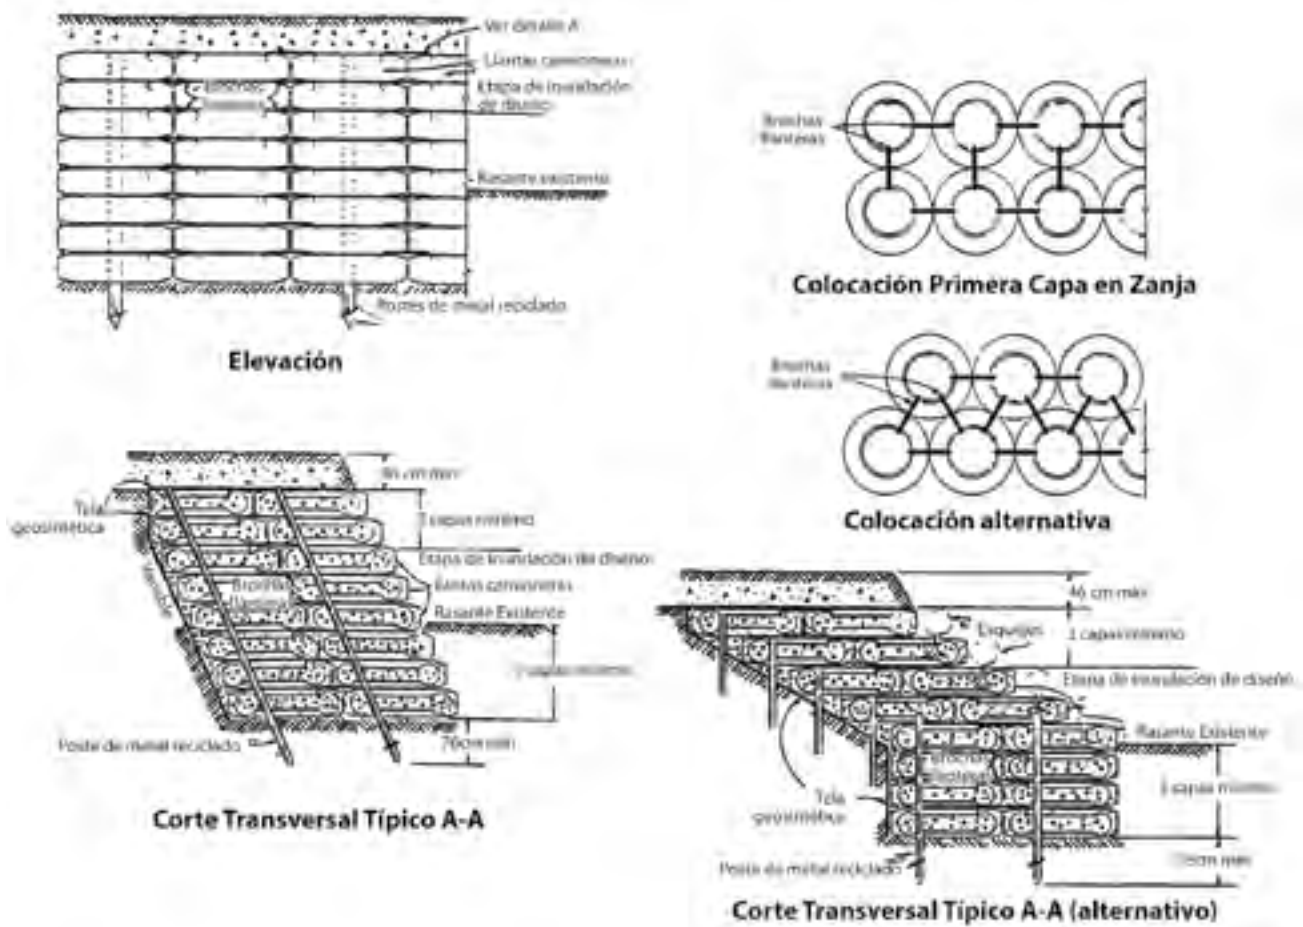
Sistema de muros de retención construidos con llantas enteras (Ref. 6)
